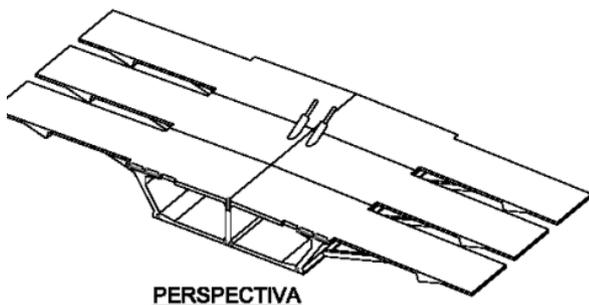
Disposición de dovelas prefabricadas en el vano central
